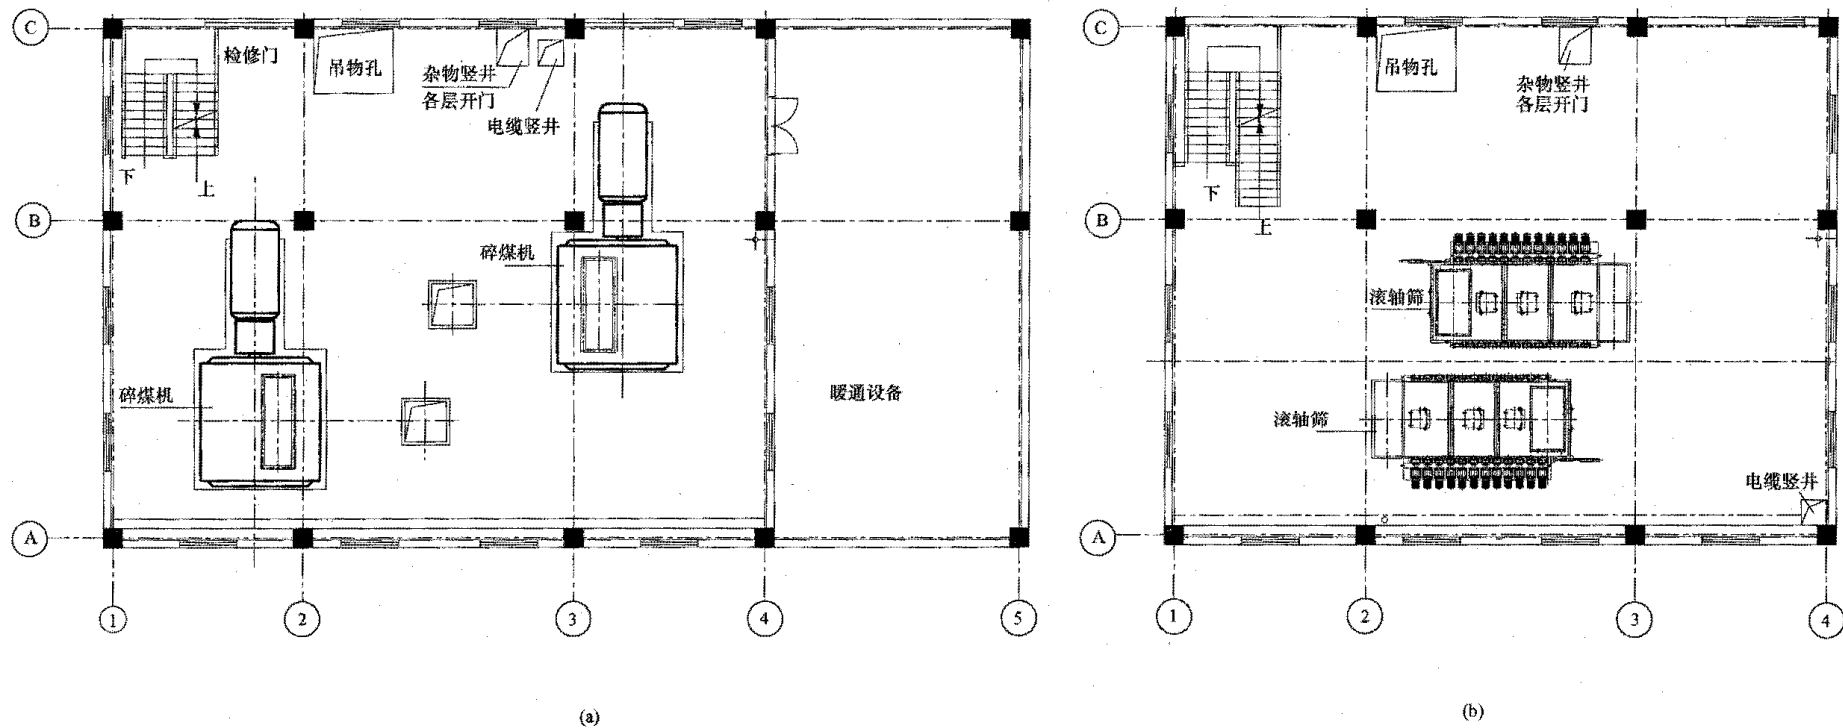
碎煤机平行于皮带的平面布置图 (一)
